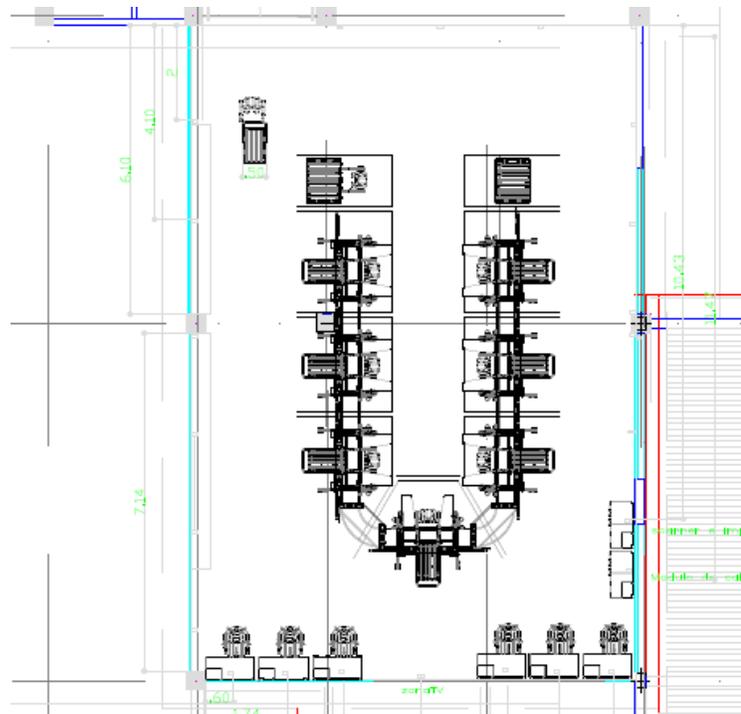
Planos arquitectónicos de la FA universidad EAFIT
